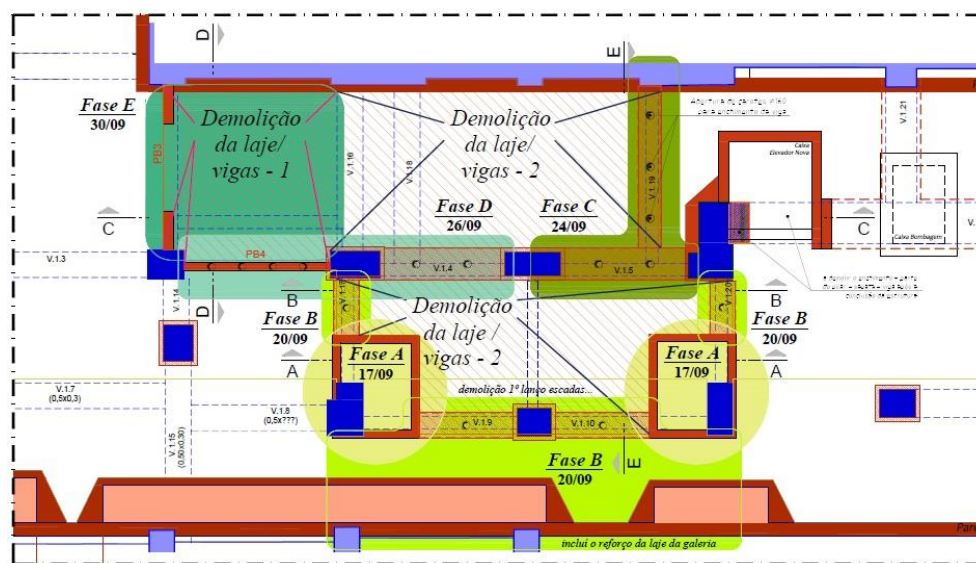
Esquema do faseamento da demolição da laje do Piso 0
